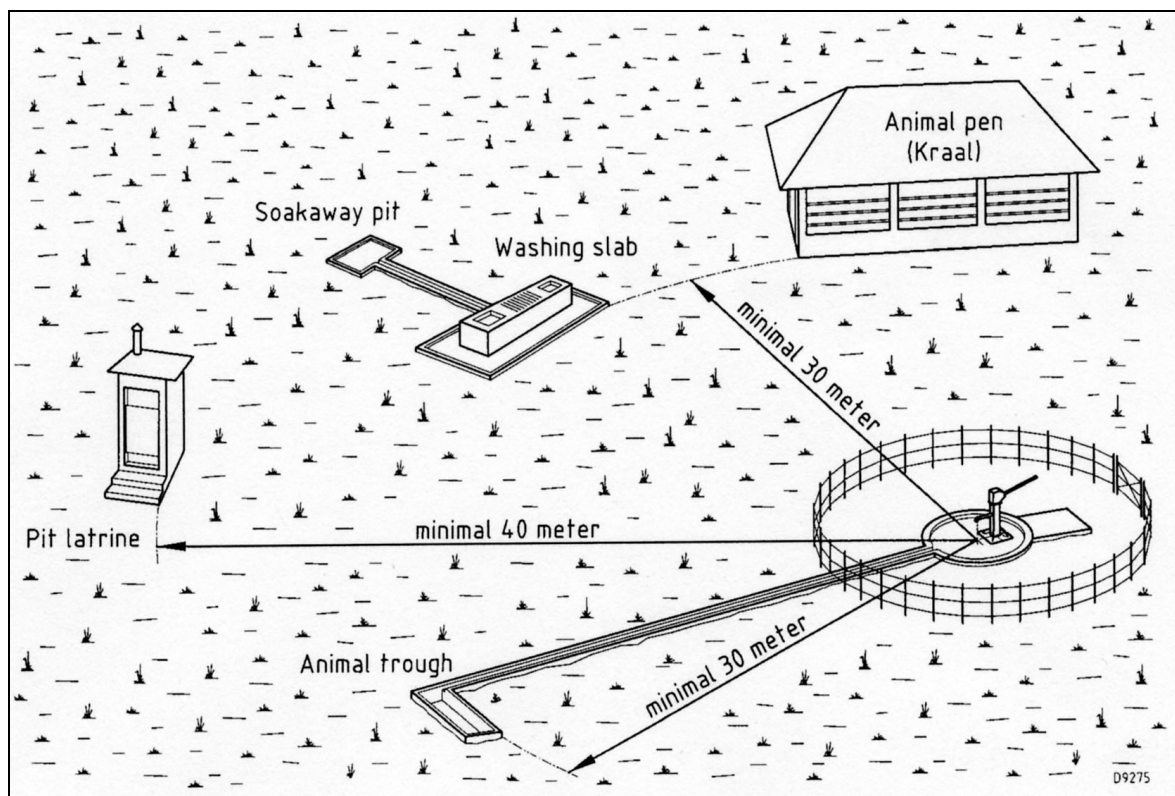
Idealer Standort einer Wasserzapfstelle (SKAT Foundation 2002, S. 10)
